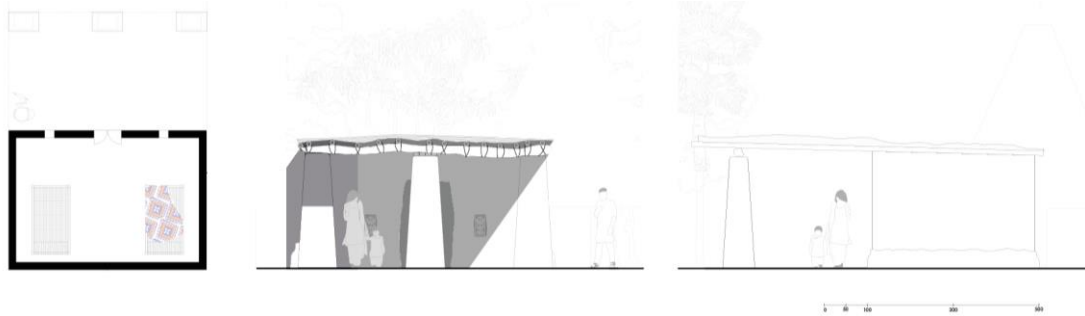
Grundriss und Schnitt, Rechteckiges Haus 2 (Quelle: Windisch, 2023)
